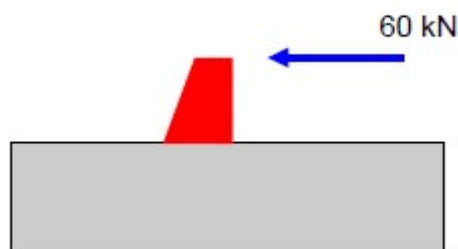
Força no guarda-rodas (Fonte: Manual de projeto e construção de pontes de madeira – LaMEM)
